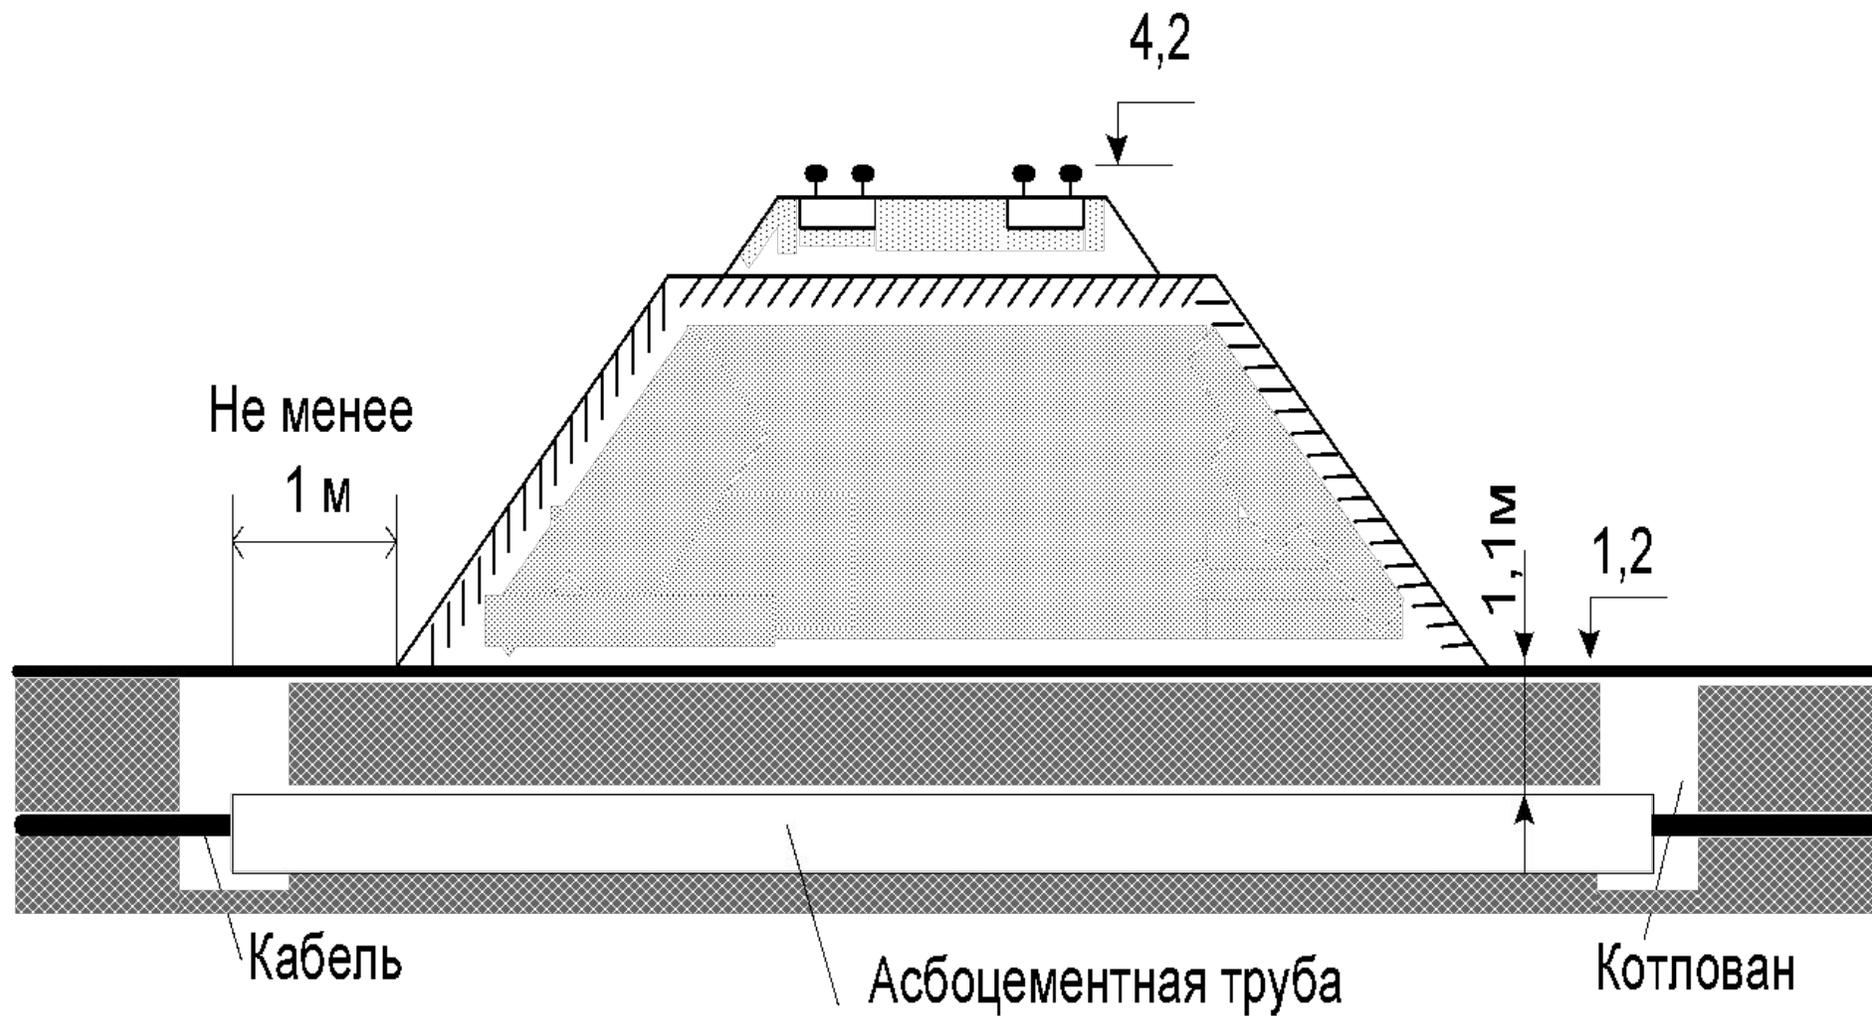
Прокладка кабеля под железнодорожной насыпью
